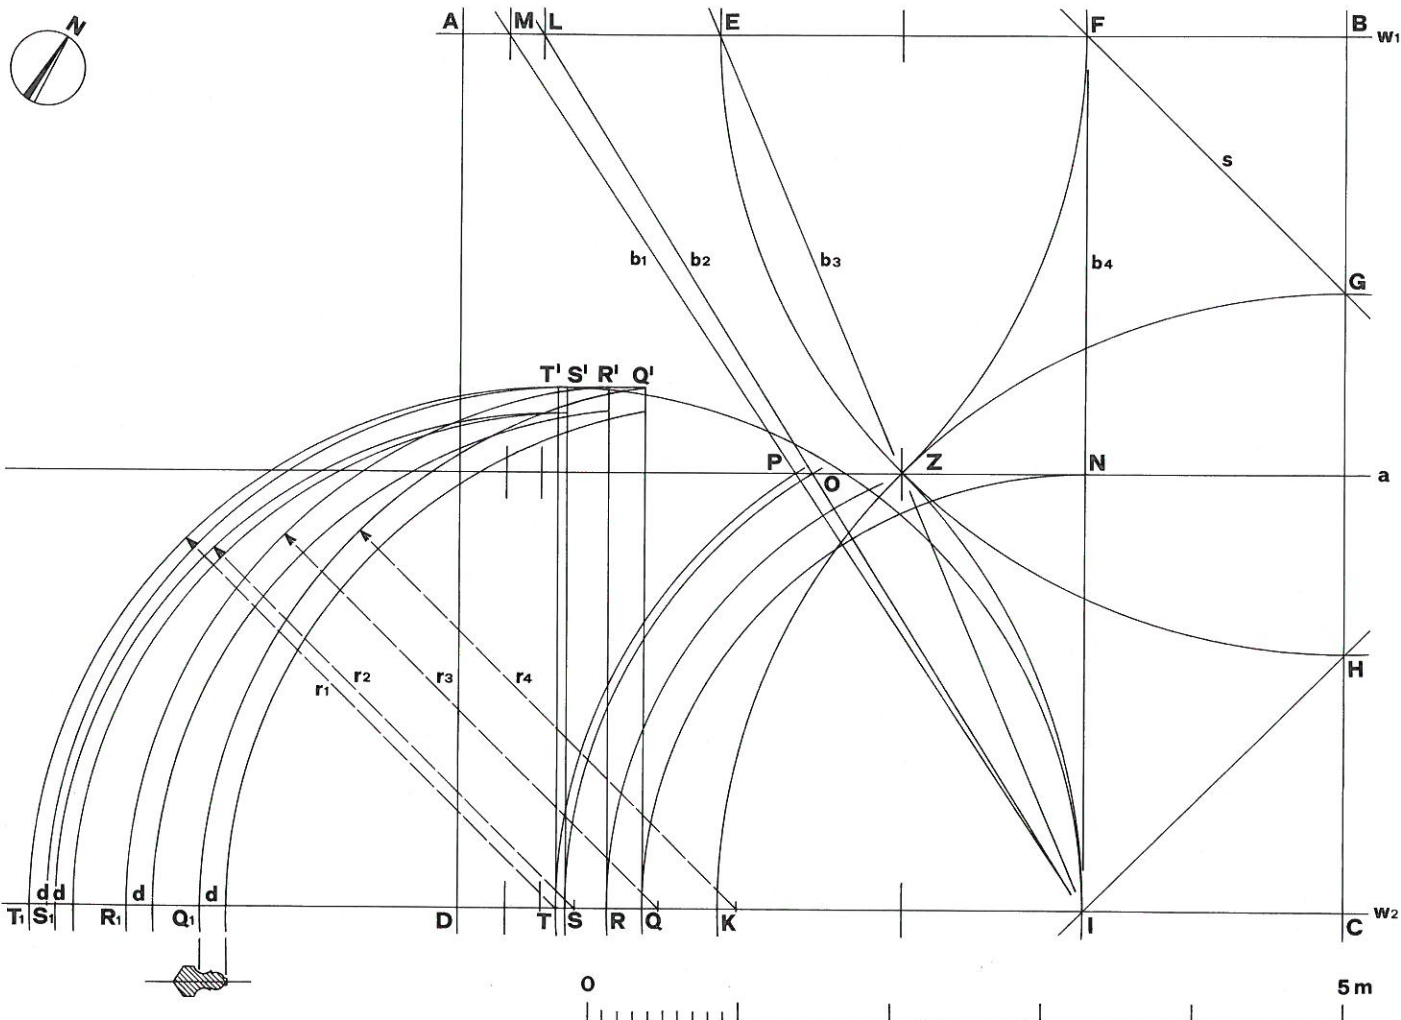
Schematische Darstellung des Reissbodens mit den mutmasslichen Konstruktionen zuhanden des Grundrisses und der Gewölbe in Altarraum und Vorjoch.
